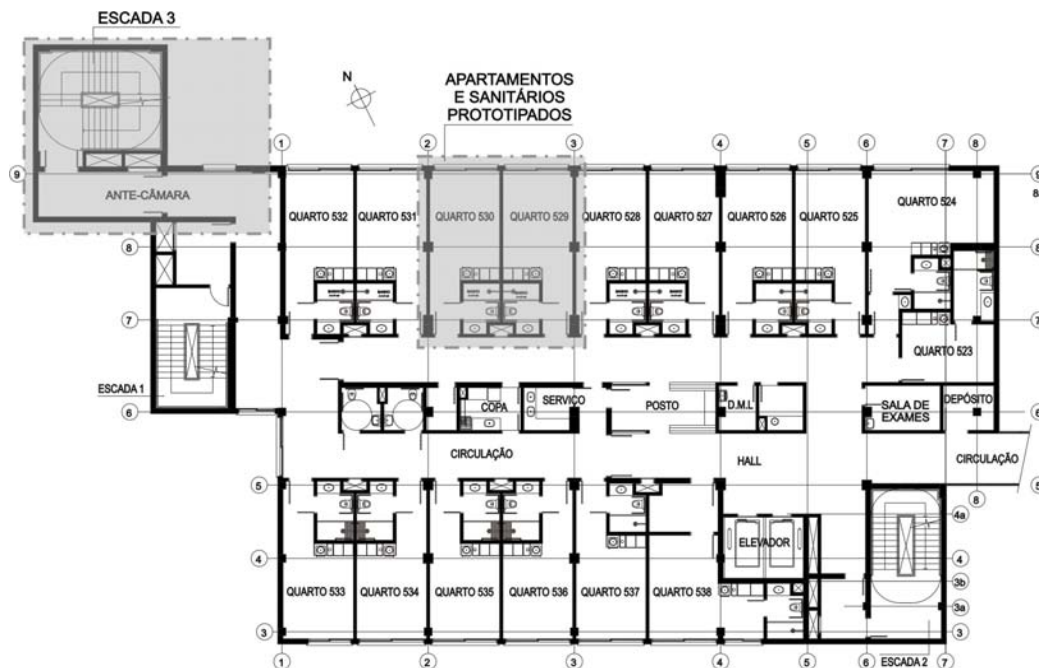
planta do 5º pavimento do pavimento tipo do edifício da internação com destaque à escada 3 e ao conjunto de dois sanitários e dois apartamentos prototipados, sem escala.
